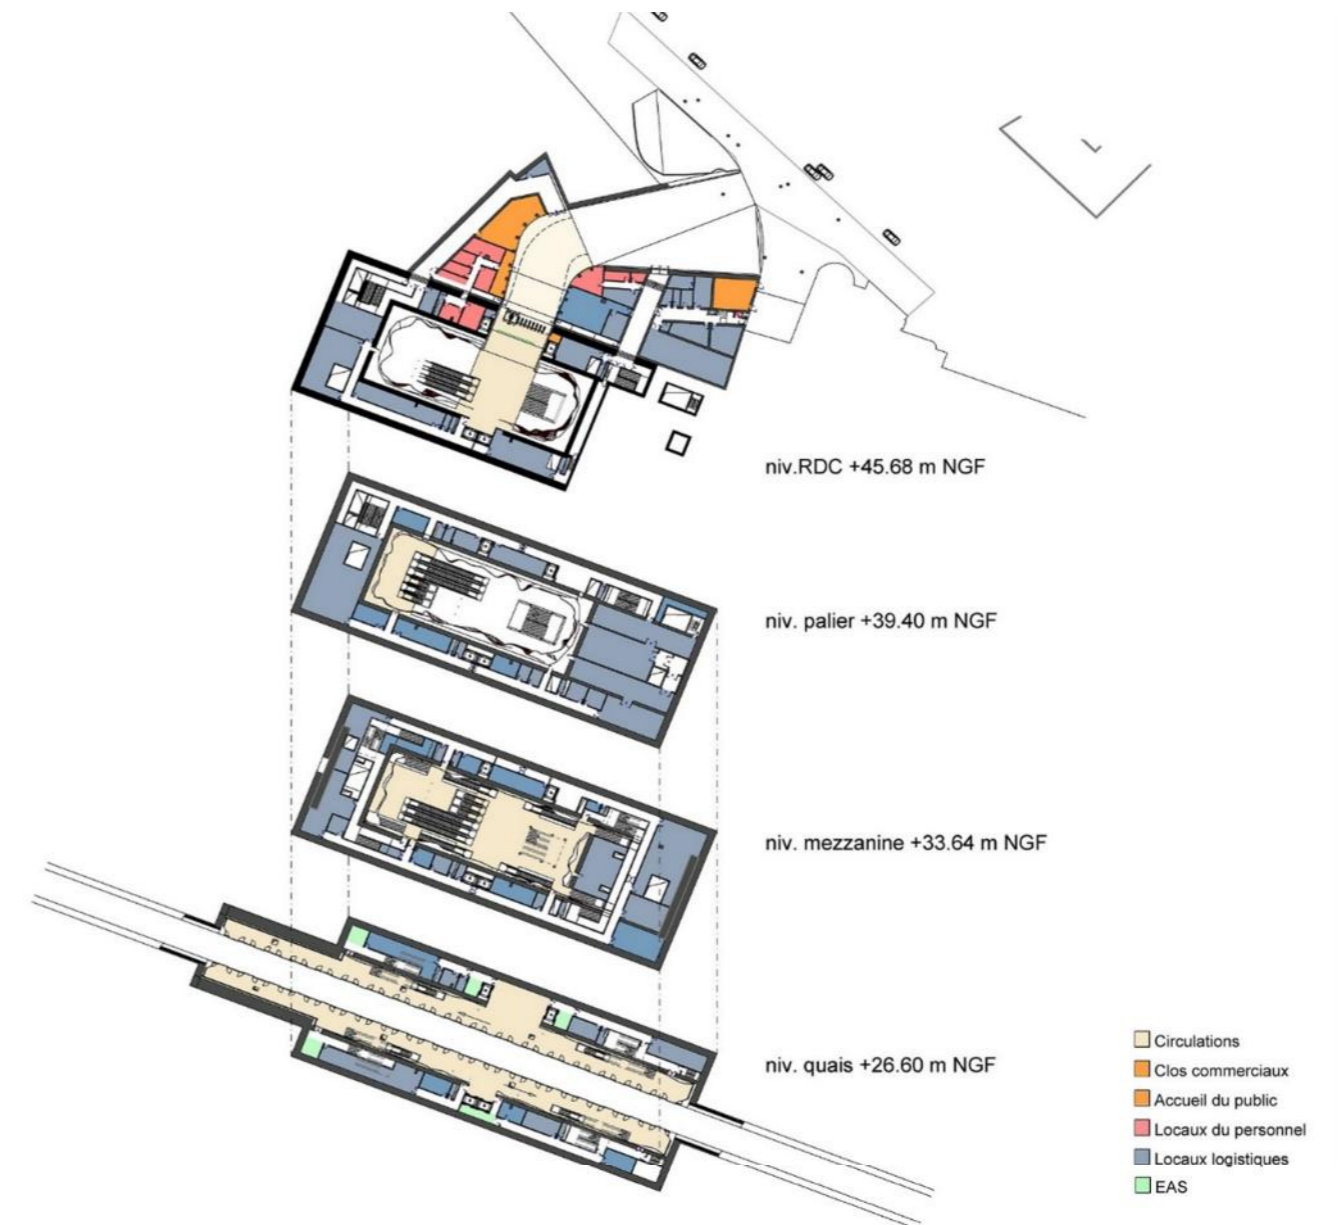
vues en plan de la gare de Vitry Centre, AVP, 10-11-2014
